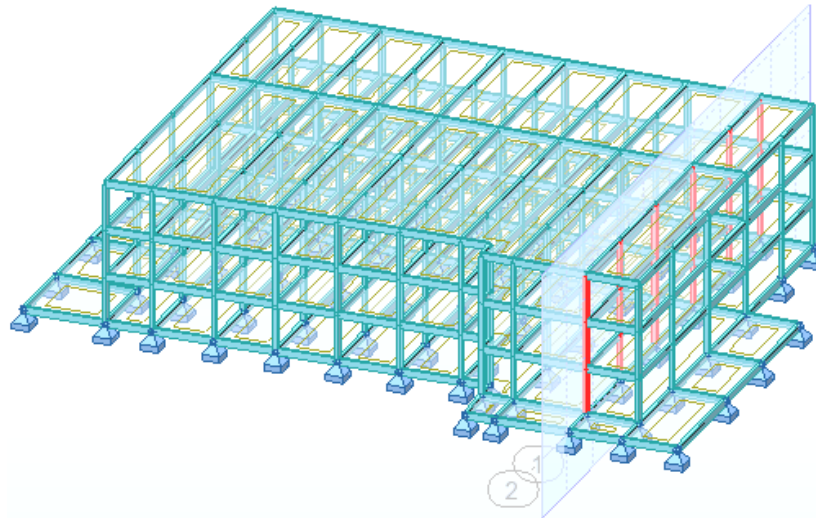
Plano que interceta os pilares que descarregam na viga B8
